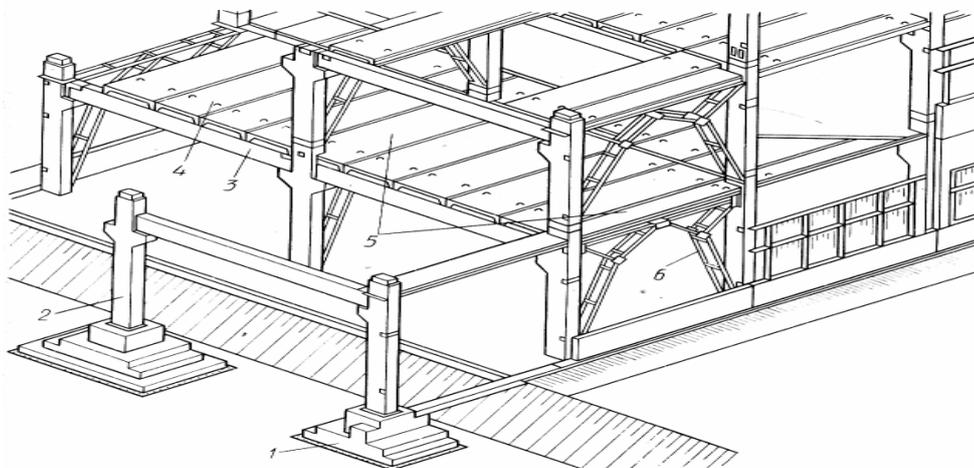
Стойко-балочний рамний каркас: 1 – фундамент; 2 – колона; 3 – прогін; 4 – настил багатоповерхового перекриття, 5 – зв'язні плити; 6 – вертикальні зв'язки.
